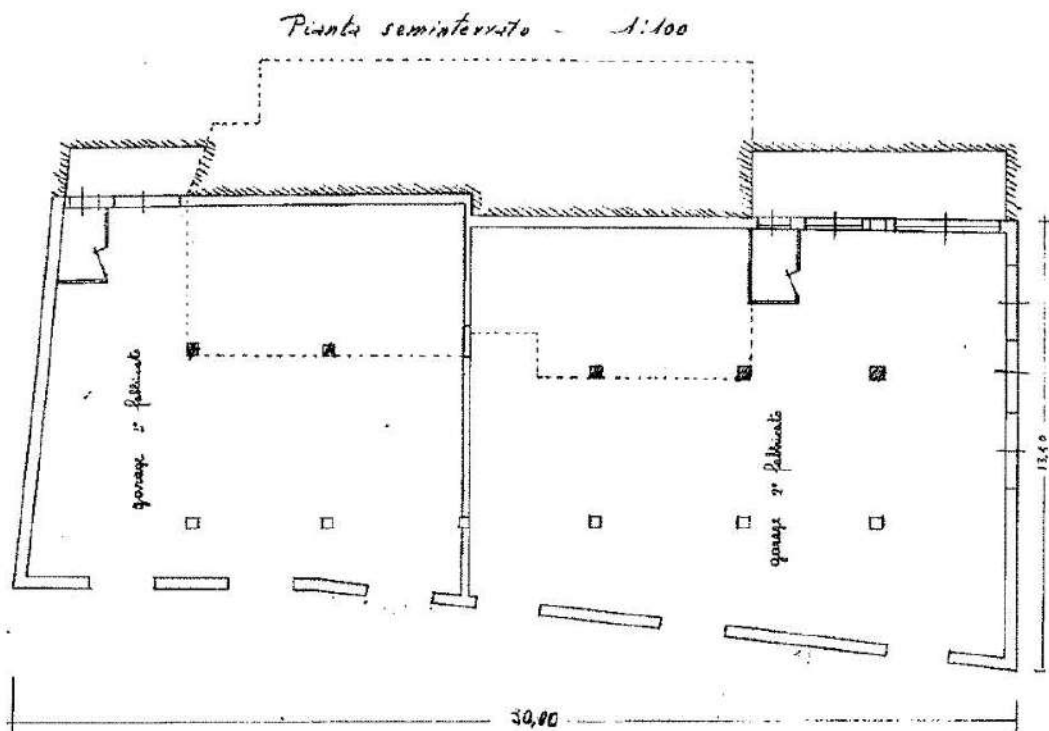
Progetto approvato dalla CE del 29/12/1961. Pianta seminterrato palazzina A
